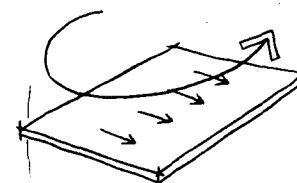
Решение 2. Поперечные диафрагмы добавлены вблизи открытого фасада
